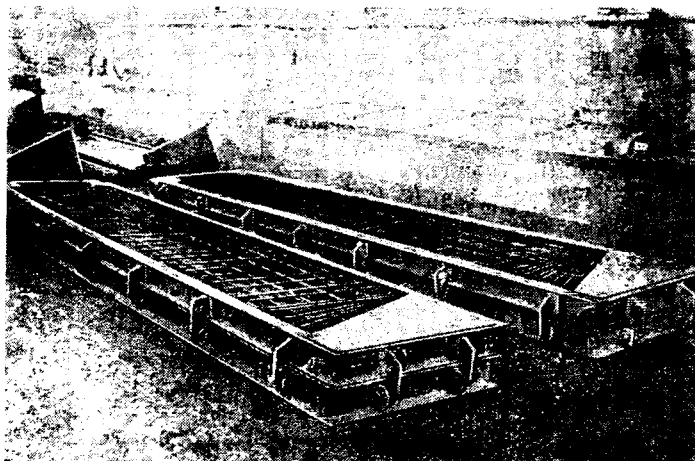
Каркасы шпунта в опалубке перед бетонированием
